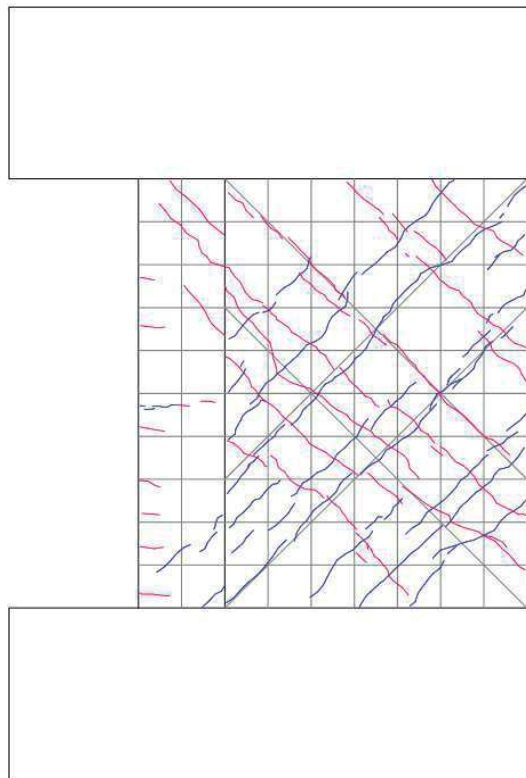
試験体 S-06-D II 事前加力終了時 (2/1000rad.) ひび割れ図
